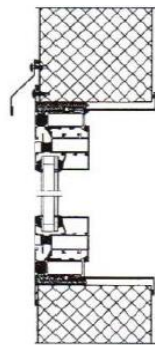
Pormenor da ligação do Painel a uma janela (adaptado de [11]).
